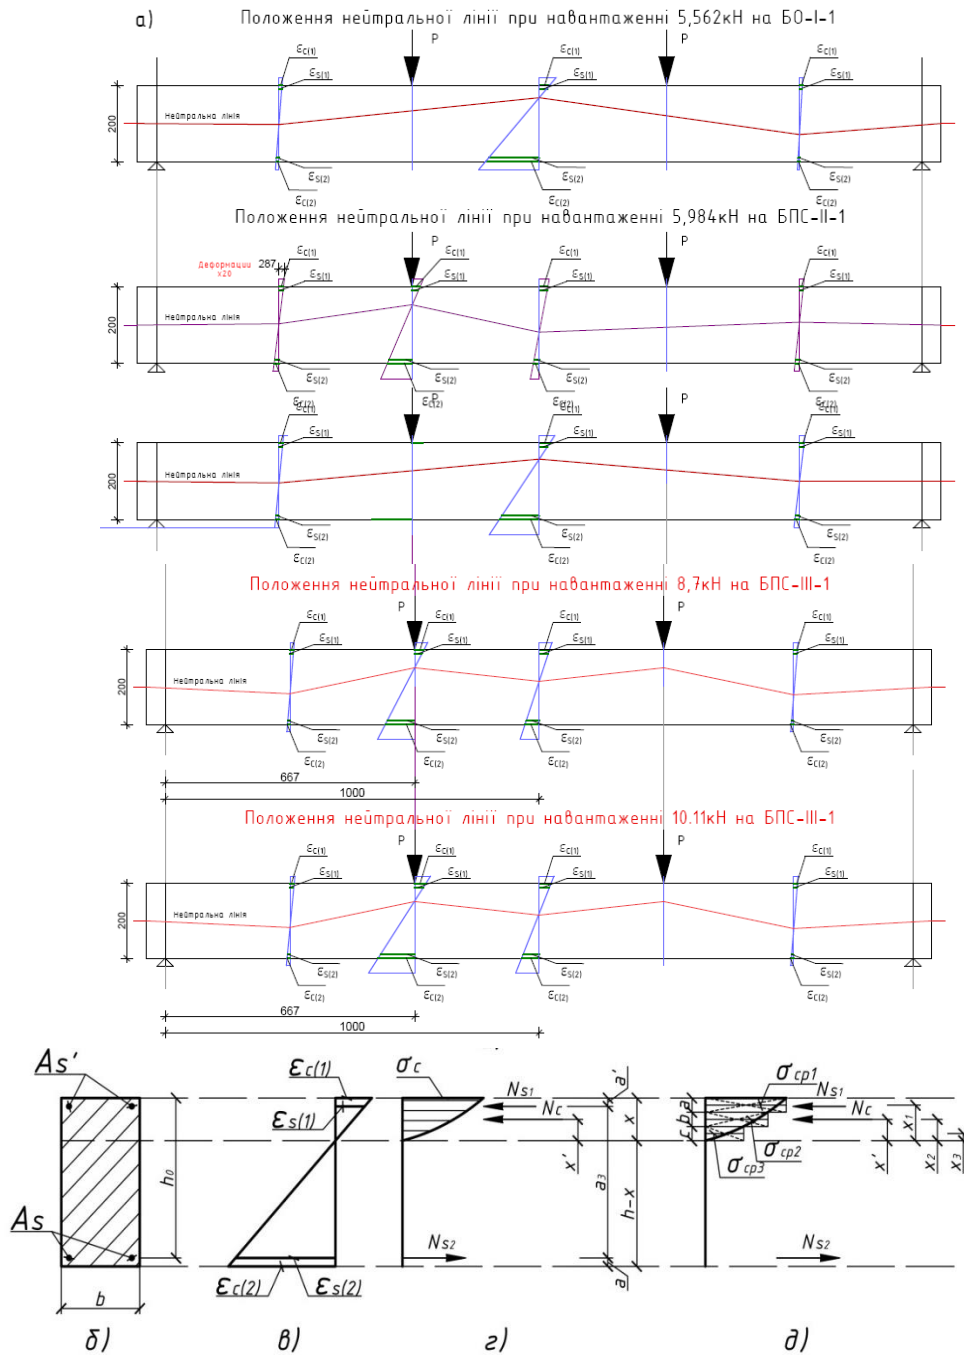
Схема деформацій, напружень та зусиль в поперечному перерізі балки серії БПС-ІІ, БПС-ІІІ: а) схема балки; б) поперечний переріз; в) епюра напружень; г) розрахункова схема зусиль
